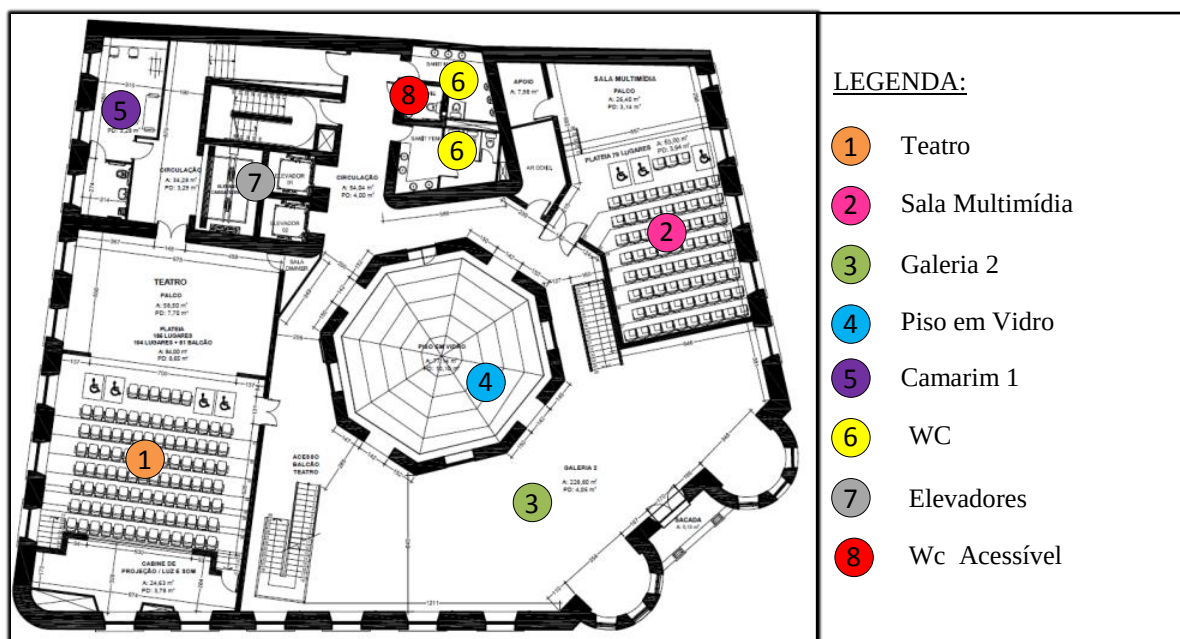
Planta Baixa do Instituto Cultural da Caixa - Térreo
